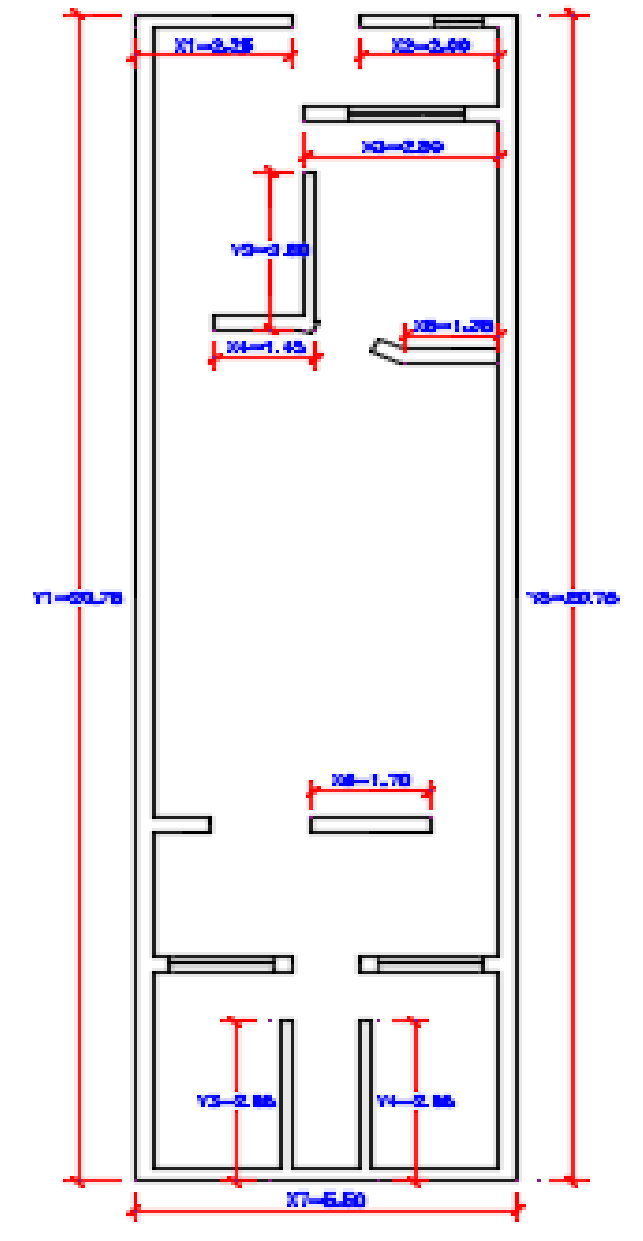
Muros portantes de Vivienda 25, vista de planta.
